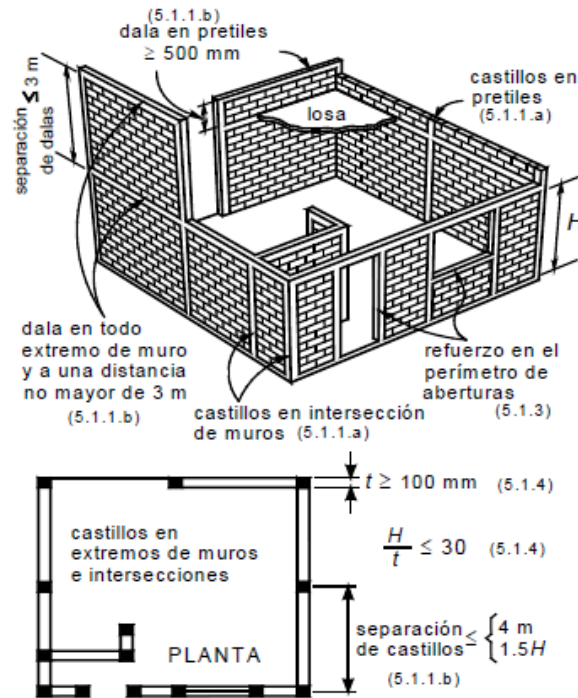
Requisitos para mampostería confinada (NTC, 2004).
